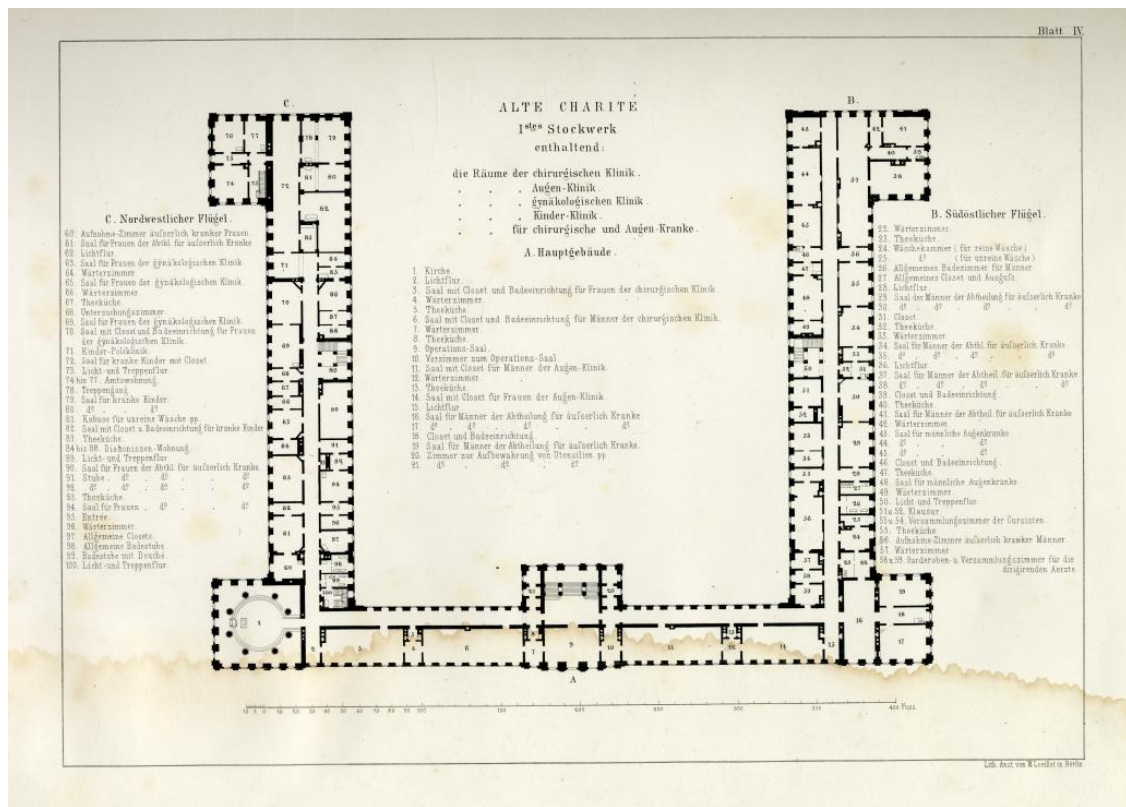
Grundriss der Alten Charité, 1. Stockwerk mit gynäkologischer Abteilung (Grundrisse 1865 Blatt IV)
